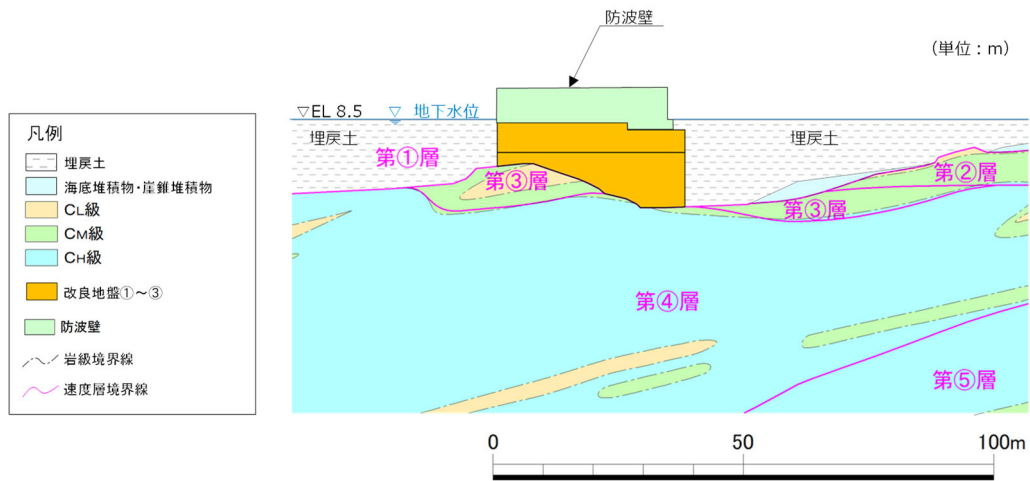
防波壁（逆 T 擁壁）の横断面図（⑦-⑦断面）
